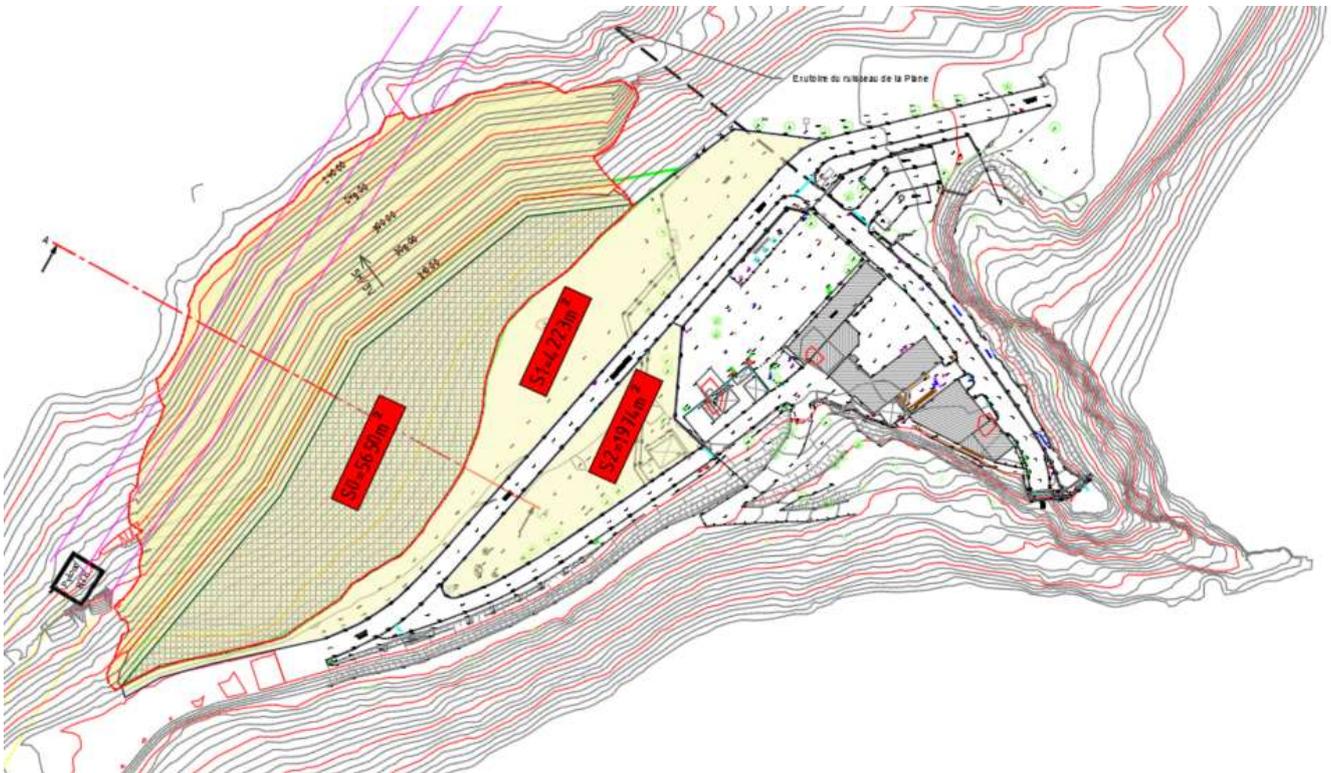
Vue en plan de l'aire de stockage en face de l'usine
